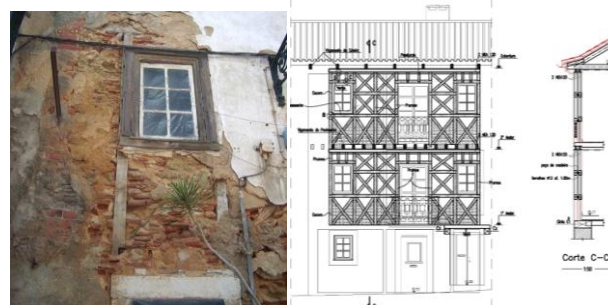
Estado de degradação da parede de frontal da fachada do Lote 83. Alçado com a reconstrução da parede de frontal.
